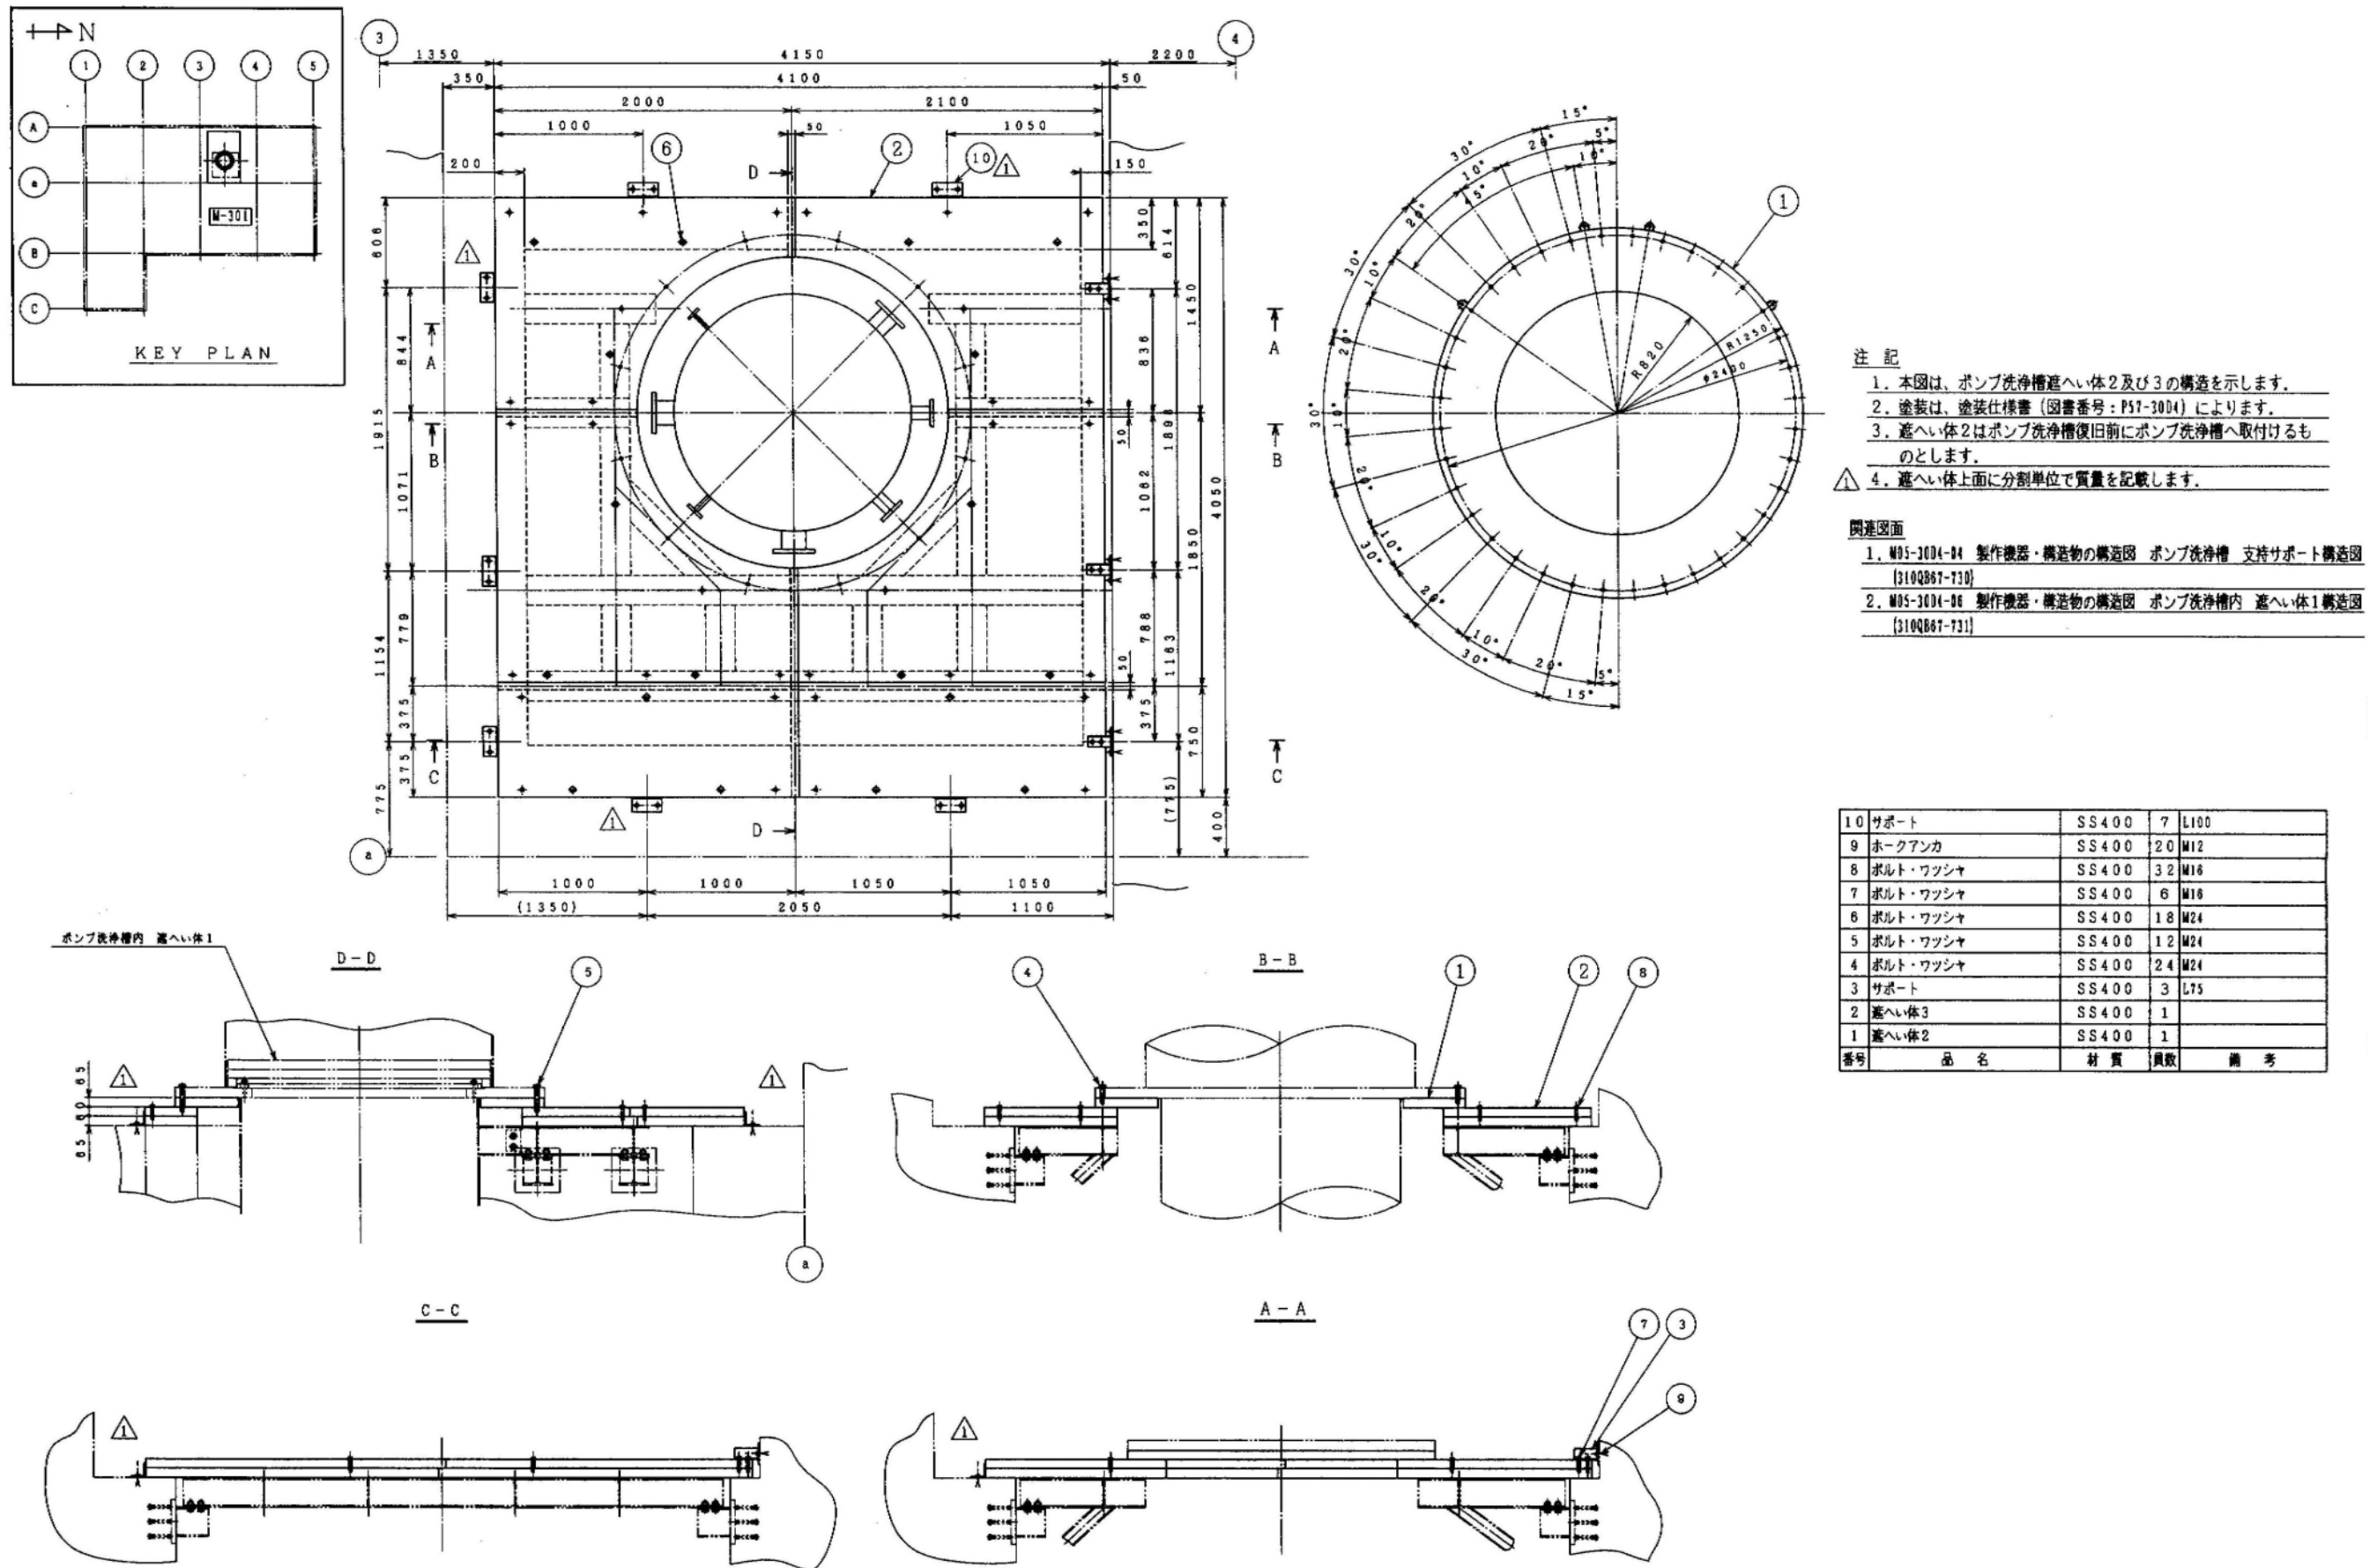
ポンプ洗浄室開口部の遮へい体構造図
